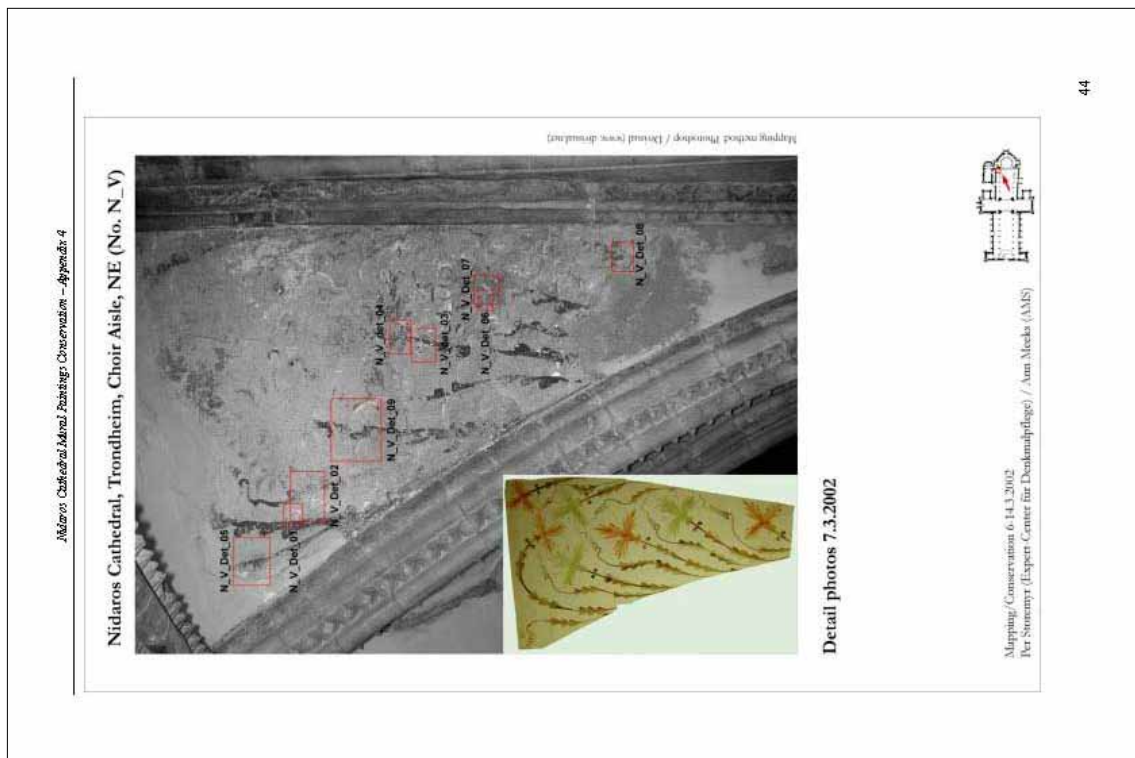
Grafická dokumentace – Restaurátorský zásah - Storemyr, P., Conservation of Mural Paintings and Paint on Stonework in the Choir’s North Aisle Vault, Nidaros Cathedral, Trondheim, Norway, Report, 2002
